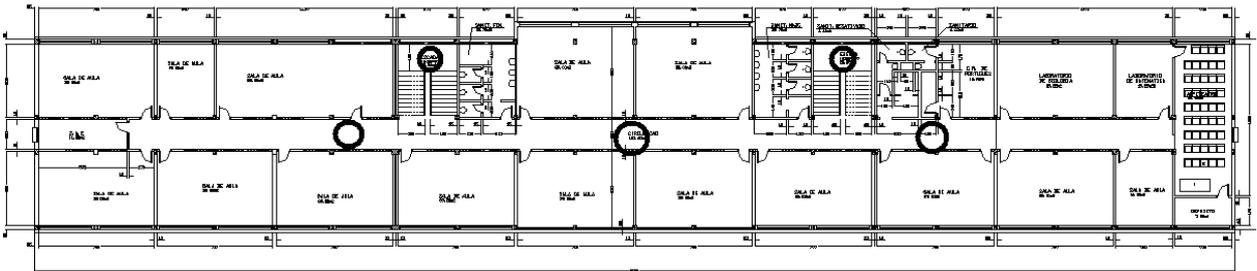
Disposição recomendada dos pontos de luz para o terceiro pavimento.
